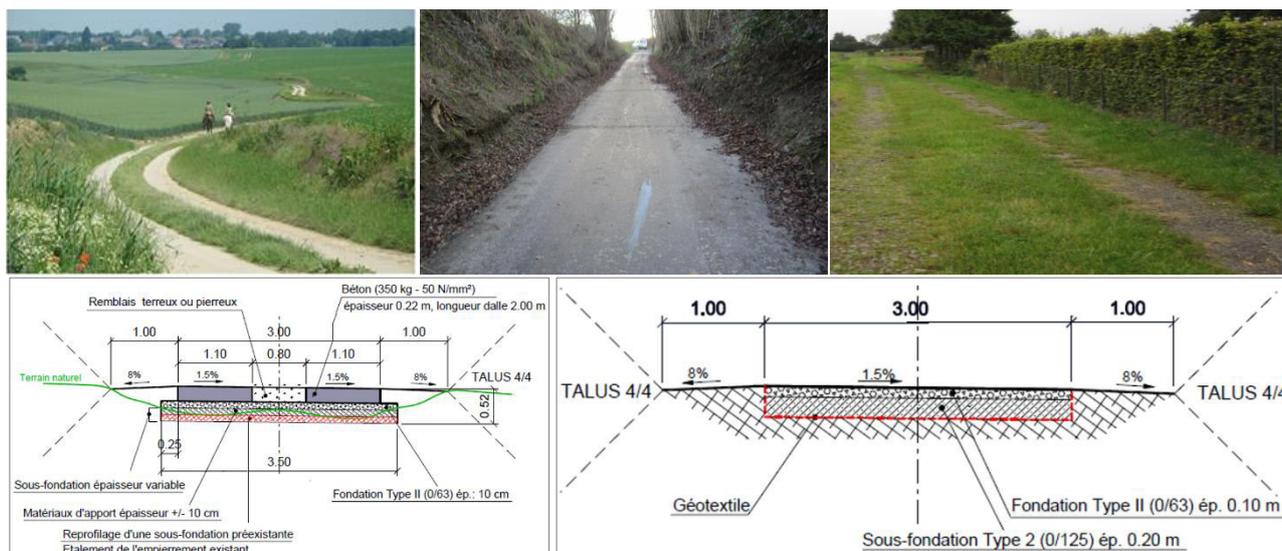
Sup : Revêtement pour les voiries agricoles : bi-bandes béton (gauche), bande béton sec compacté (centre) et empierrement (droite) ; Inf : Fondations bi-bandes béton (gauche) et empierrement (droite) (source : DAFoR, 2018)
